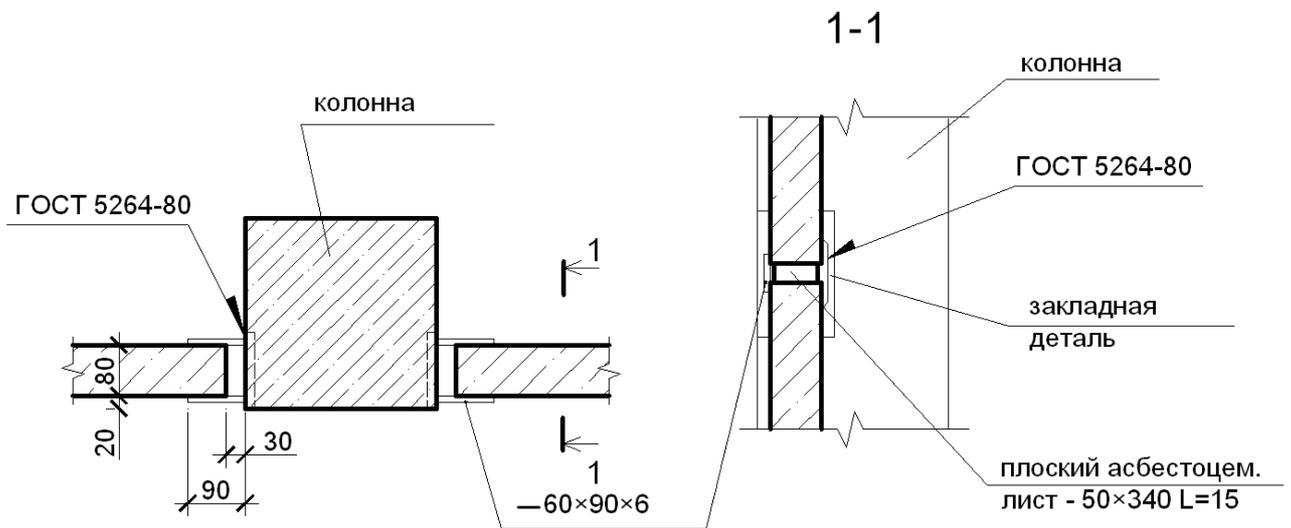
Крепление панельных перегородок между колоннами
